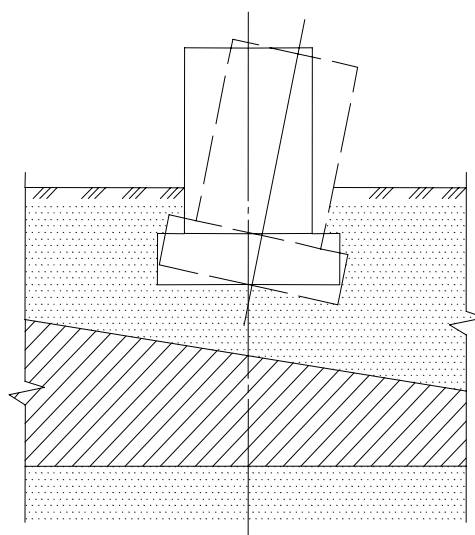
Влияние напластования слоев на крен фундамента
